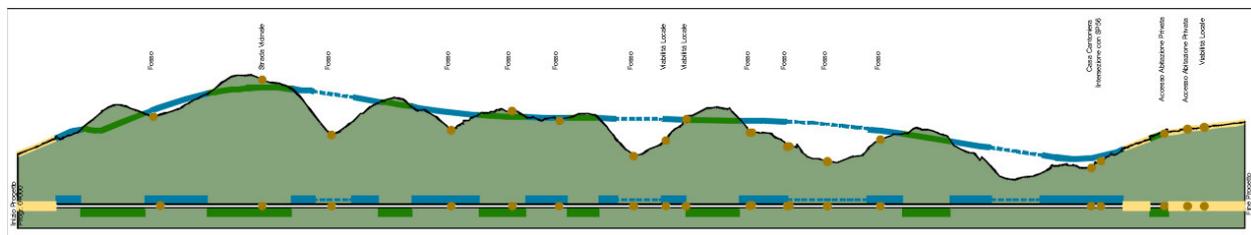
Individuazione su profilo e su diagramma del tracciato di progetto e degli elementi individuati
